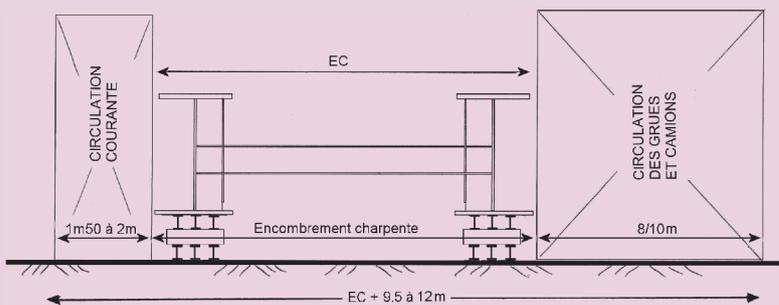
Largeur idéale de l'aire d'assemblage
